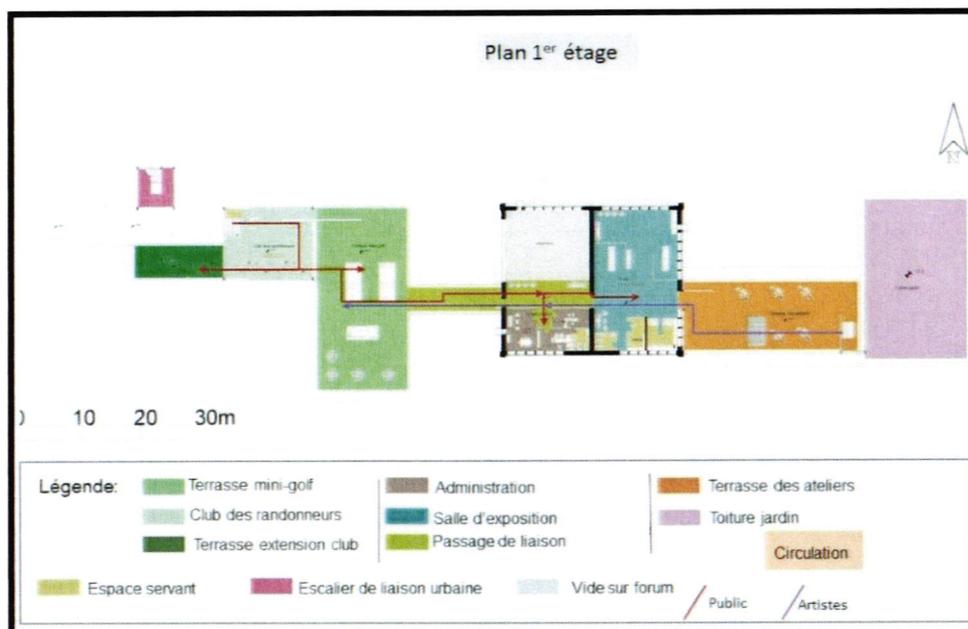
plan 1<sup>er</sup> étage (source : auteur)
